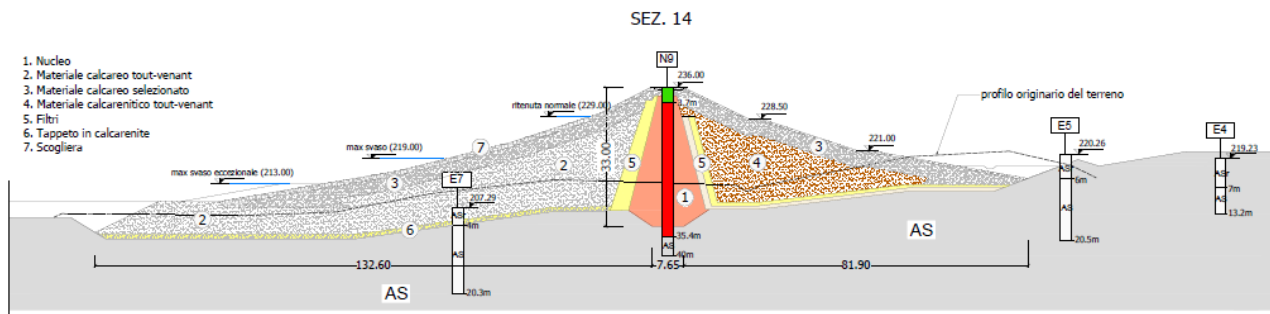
Sezione trasversale della diga numero 14 da progetto esecutivo con sovrapposizione del sondaggio N9 eseguito nella campagna d'indagine 2021.
